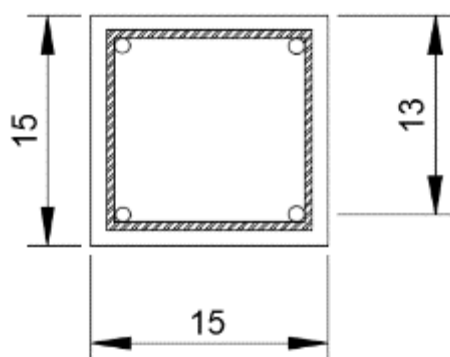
Seção das vigas 1 e 2 (Autores (2017))
